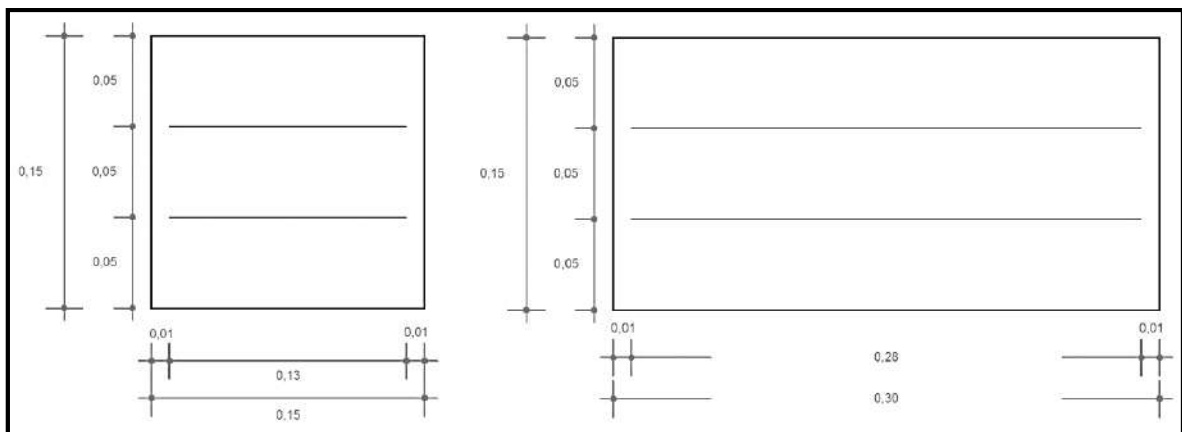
Corte transversal y longitudinal – Bloque de 2 mallas
